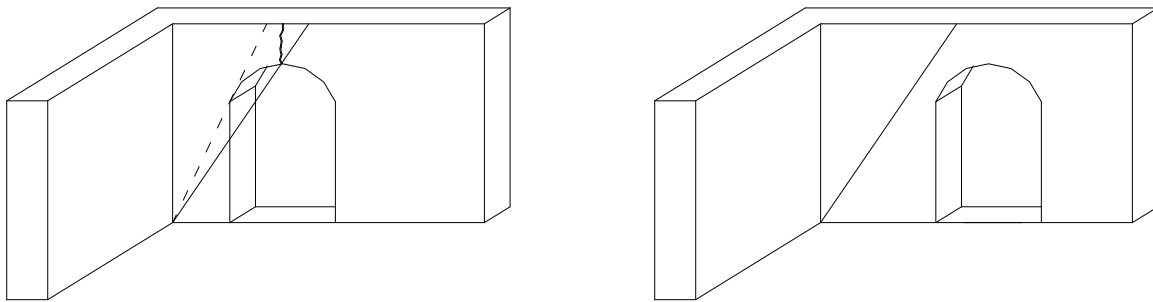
Muro di controvento con porta ad arco prossima e distante dal muro di prospetto
